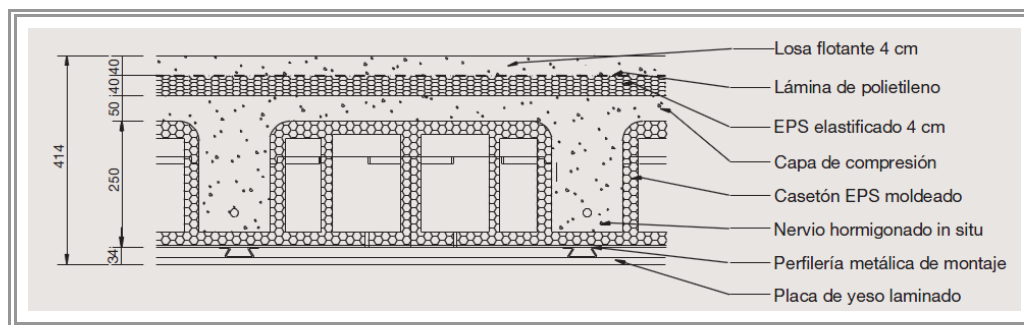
Solución de aislamiento acústico aplicado en forjado con piezas aligerantes de EPS
